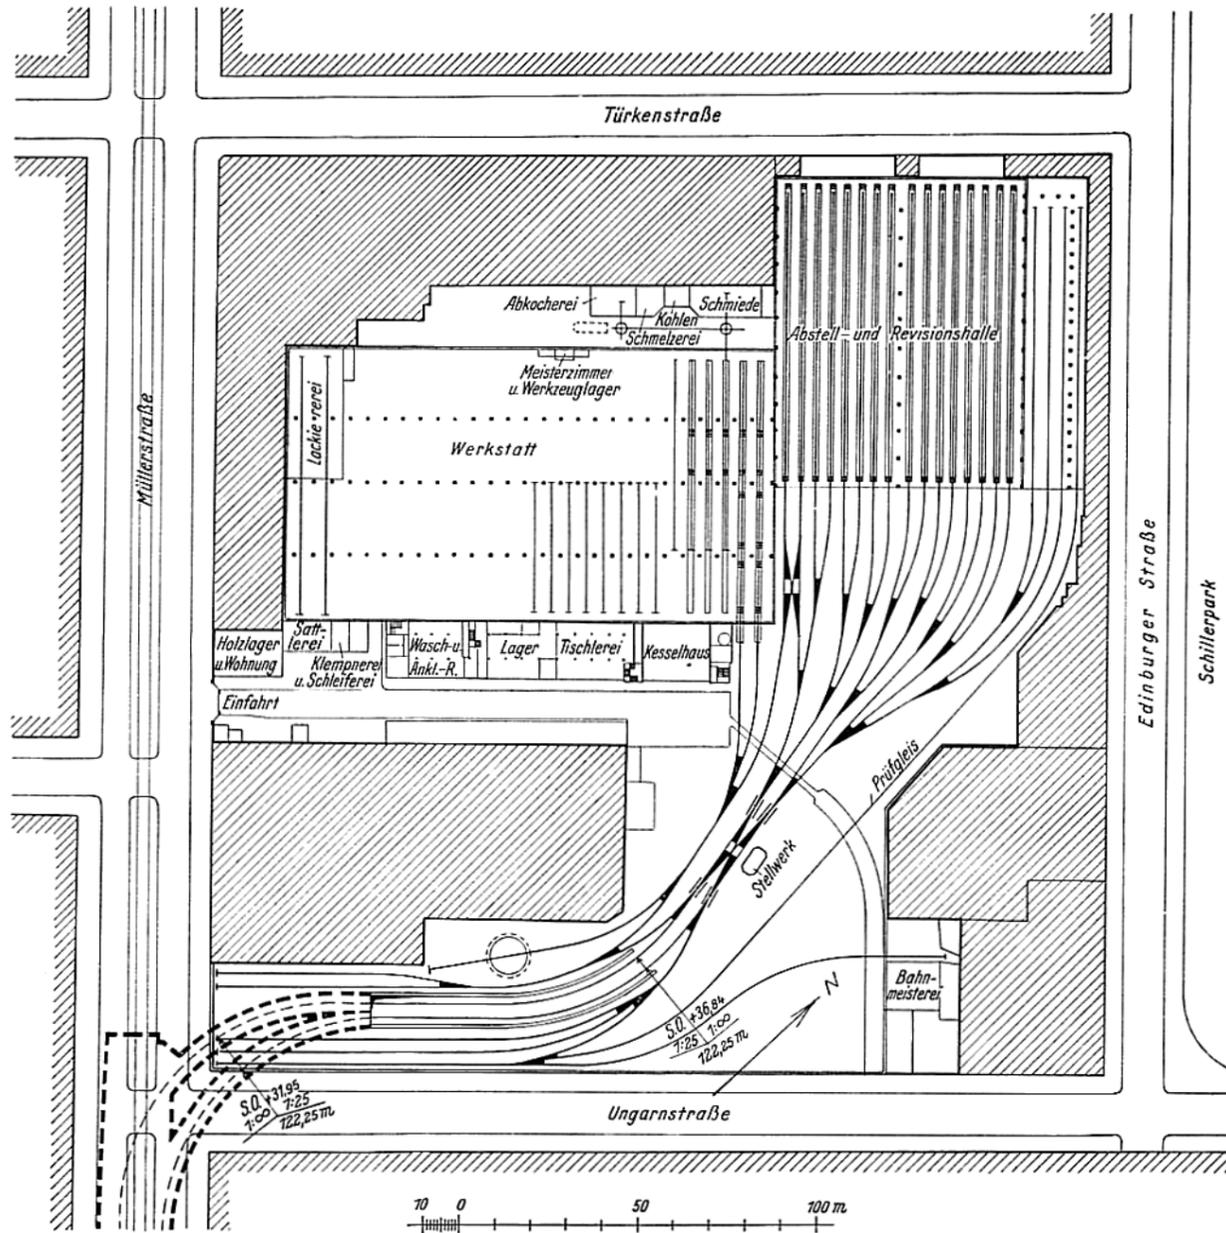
Betriebsbahnhof Seestraße, Lageplan.
